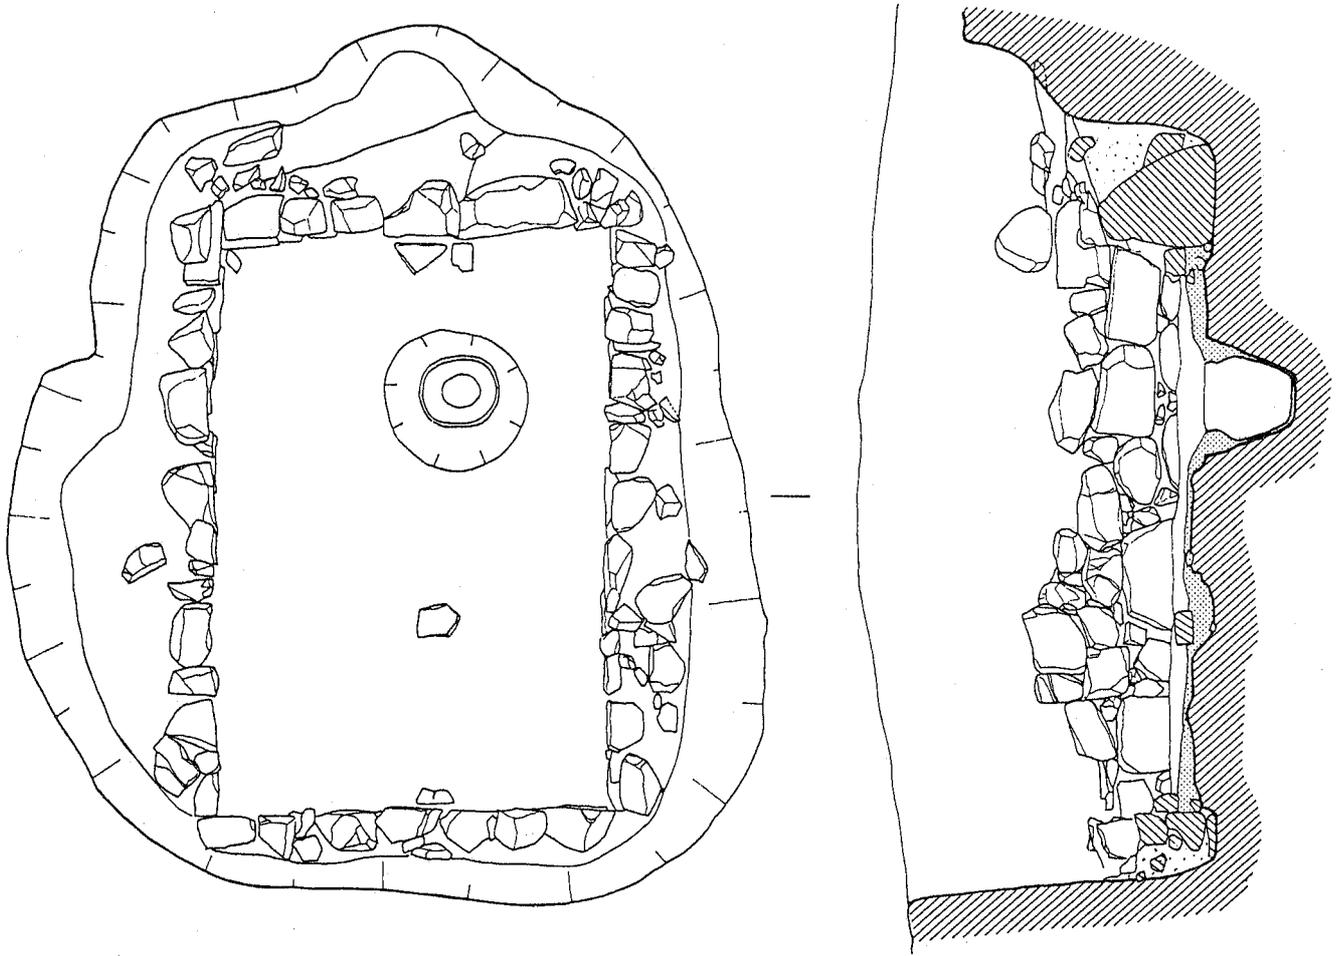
第1面町家2の穴蔵平面図・断面図(1:40)
